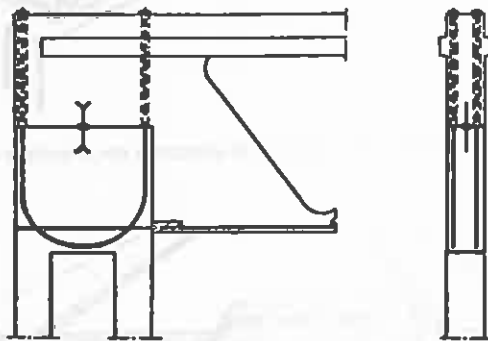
Pormenor de apoio de asna em pilar. Ver também Fig. 38 e 39
